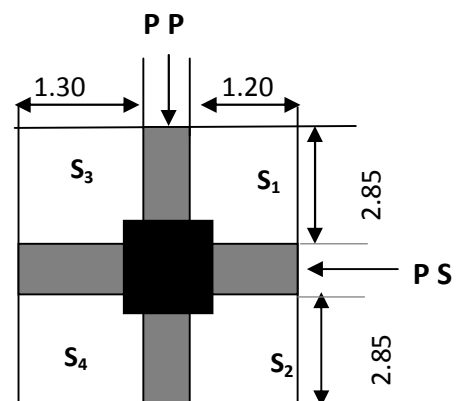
b : Surface revenant au Poteau de rive B-1(RDC(2))
